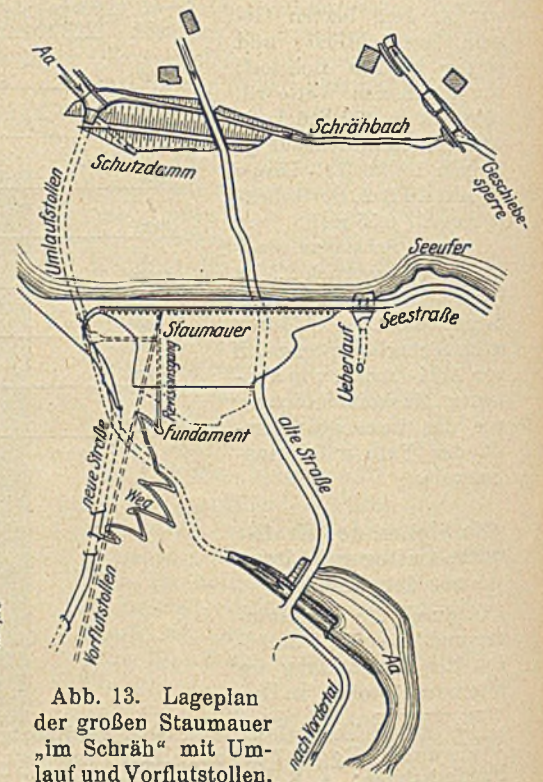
Lageplan der großen Staumauer „im Schräh“ mit Umlauf und Vorflutstollen.
